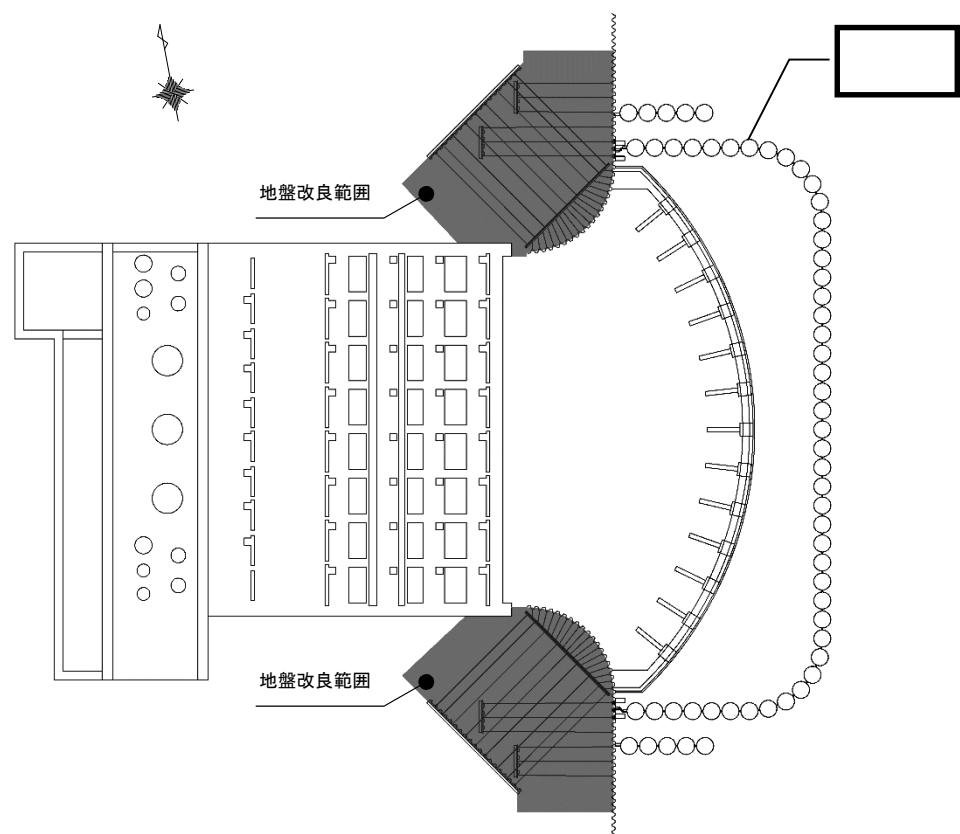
(2) 貯留堰 平面配置図 (拡大図)
